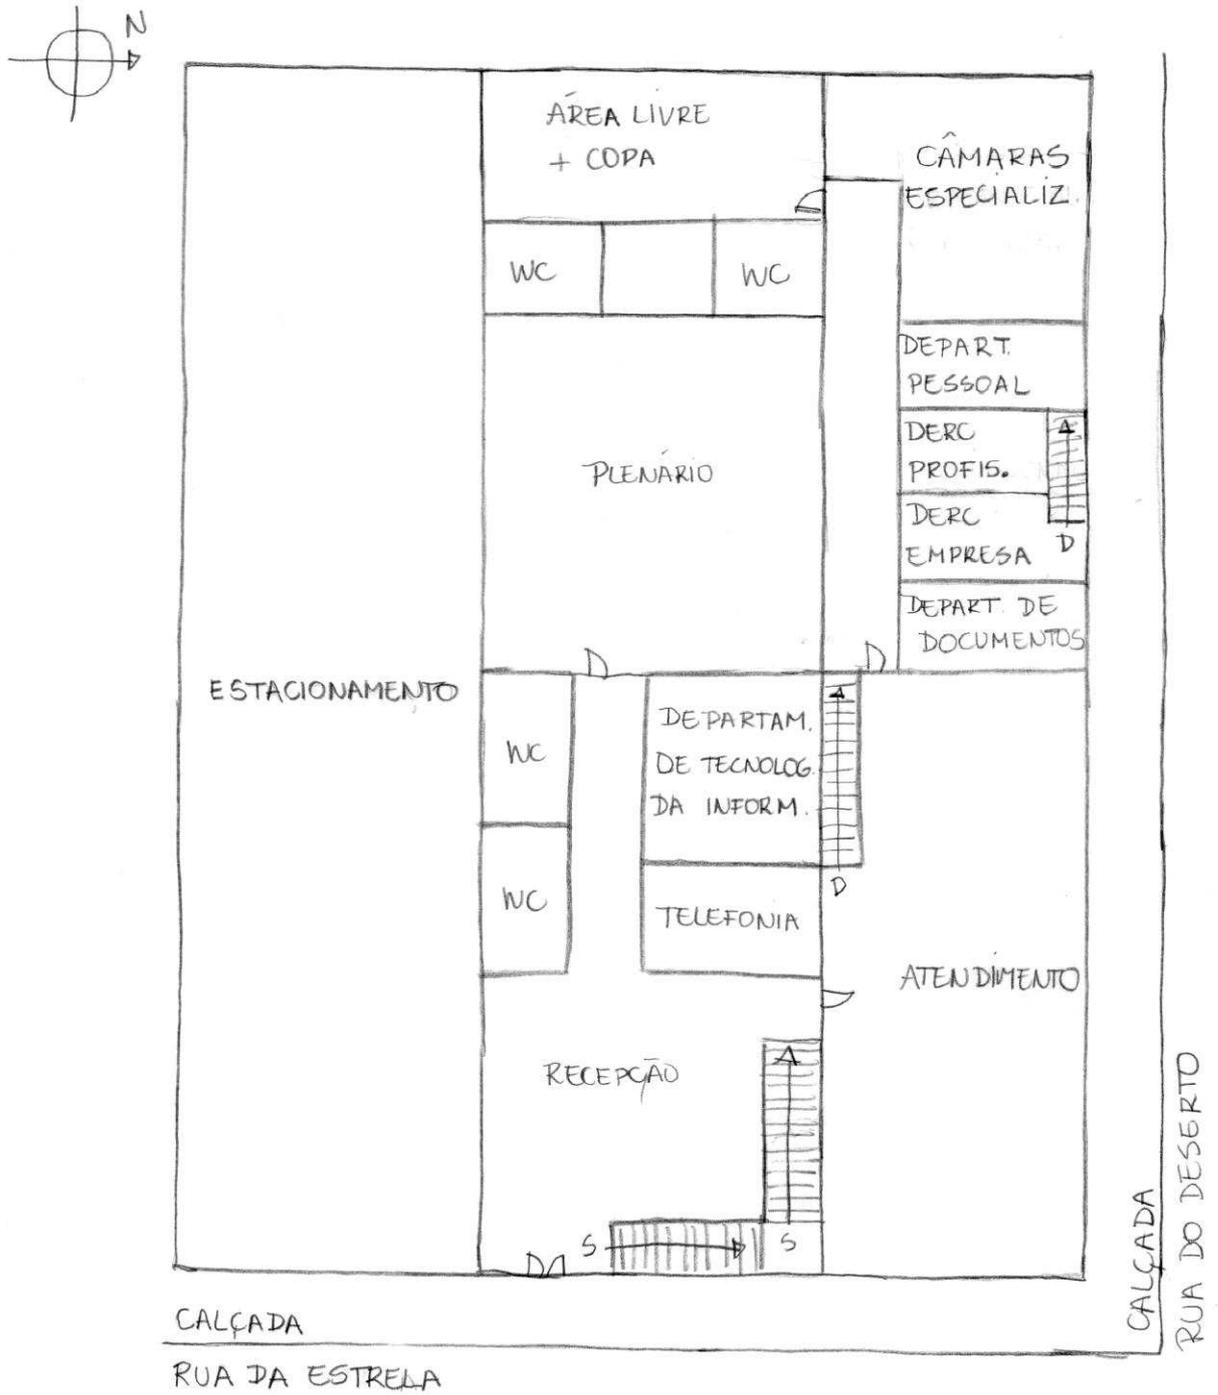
Croqui Planta Baixa Térreo CREA/MA
